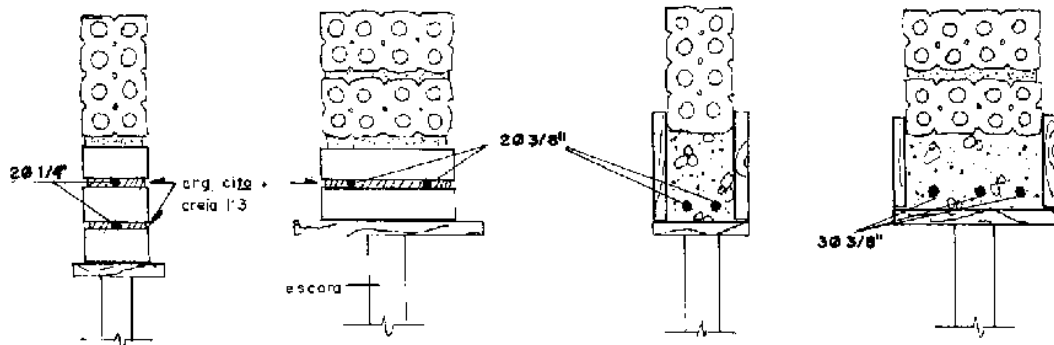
Vergas em alvenaria de tijolo furado para vãos até 1,00m e entre 1,00m e 2,00m.
